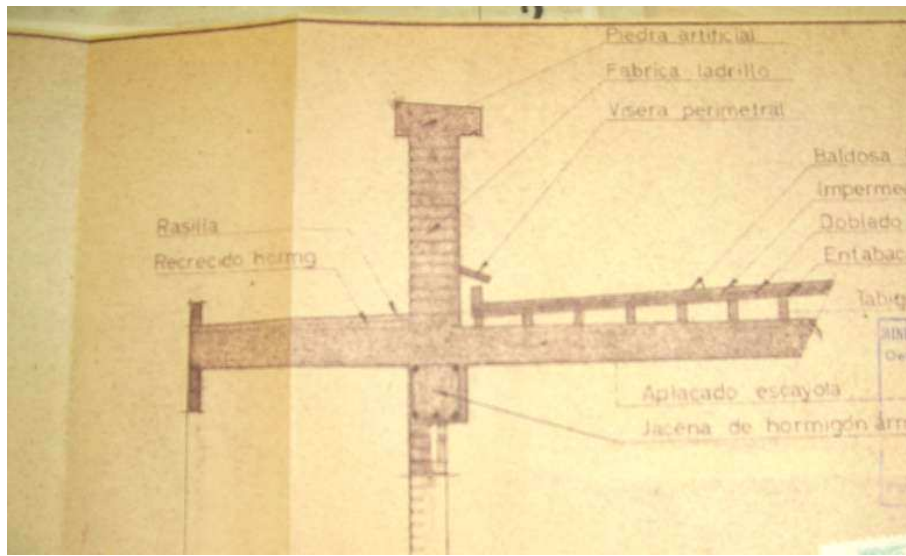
Figura IV. Detalle constructivo. Edificio ficha 133. 94C.023, 1966
